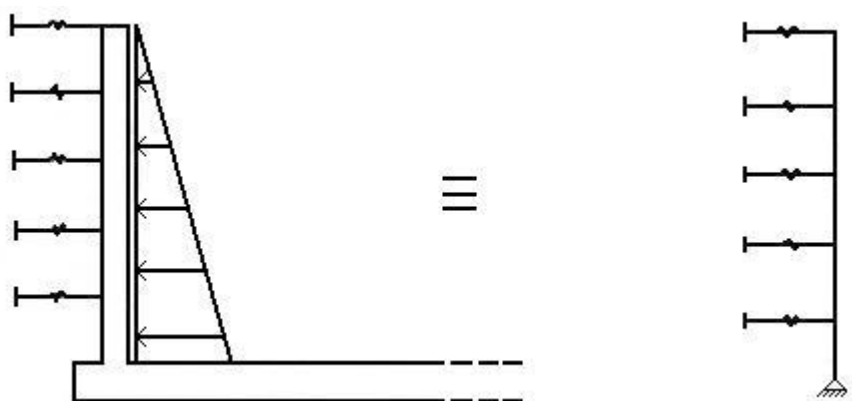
Modelo estrutural baseado na união articulada parede – laje de fundação.
